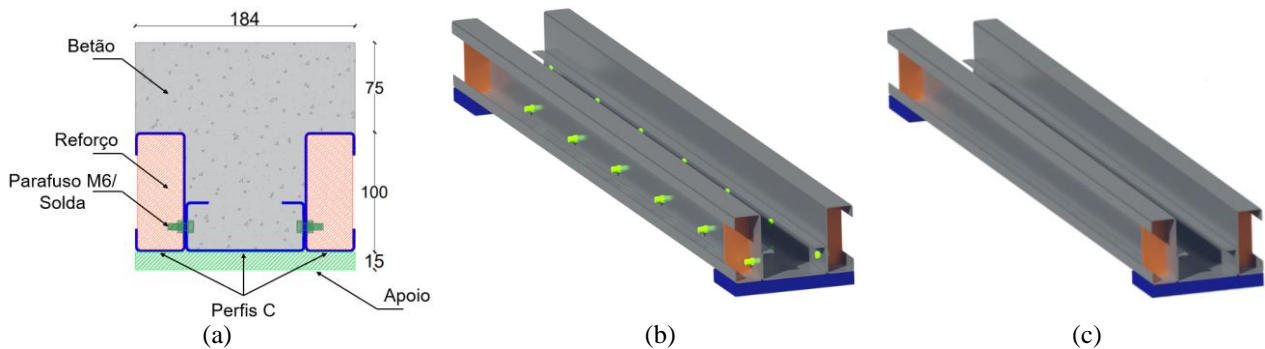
Pormenores das vigas mistas ensaiadas: (a) seção transversal; (b) vista 3D das vigas VM_P_L1.3; (c) vista 3D das vigas VM_S_L1.3.
